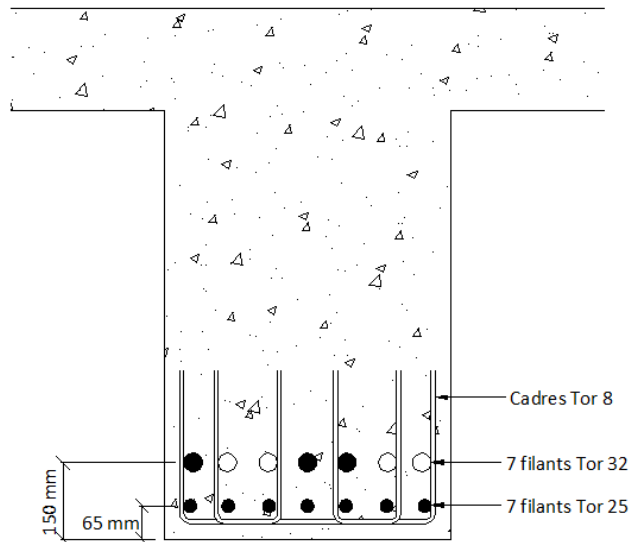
Ferraillage découvert sur la poutre Pt05 en travée 3
